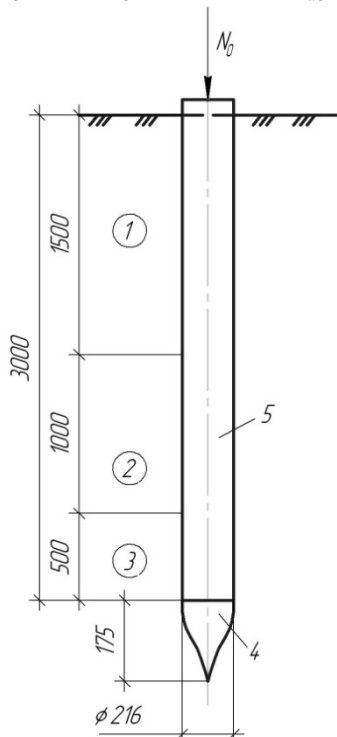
Схема буровой сваи Б-1: 1, 2, 3 – слои грунтов; 4 – тангенсоид вращения; 5 – свая
